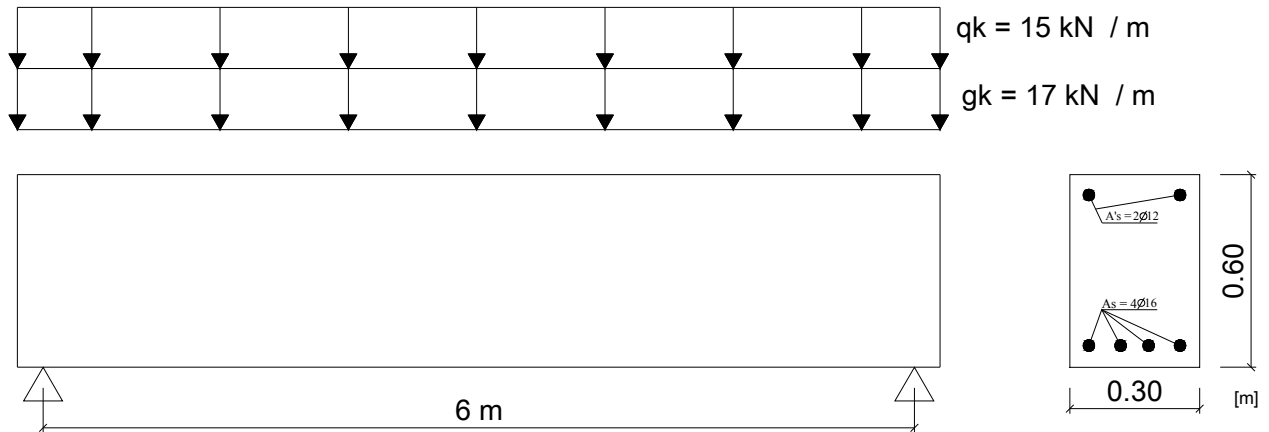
Exemplo de cálculo: Geometria da viga e acções a que está sujeita.
